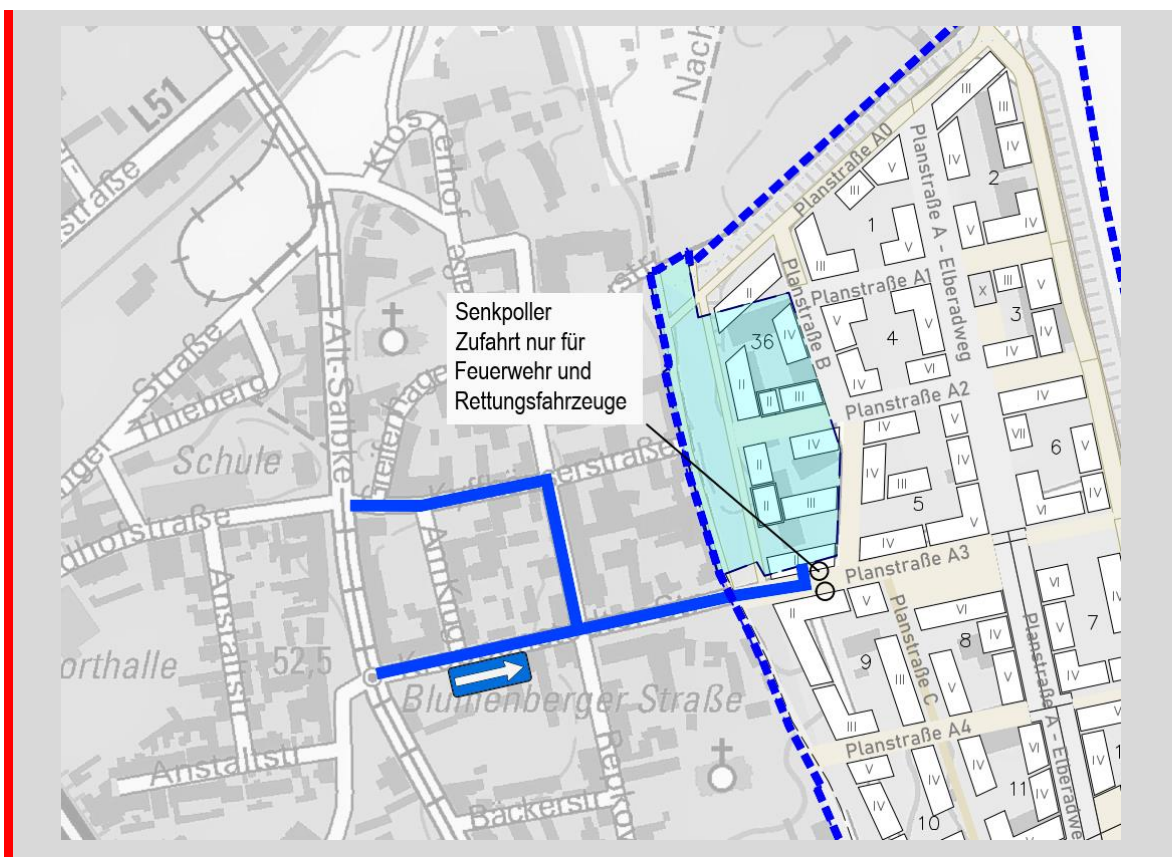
Planausschnitt Zufahrt MEB
